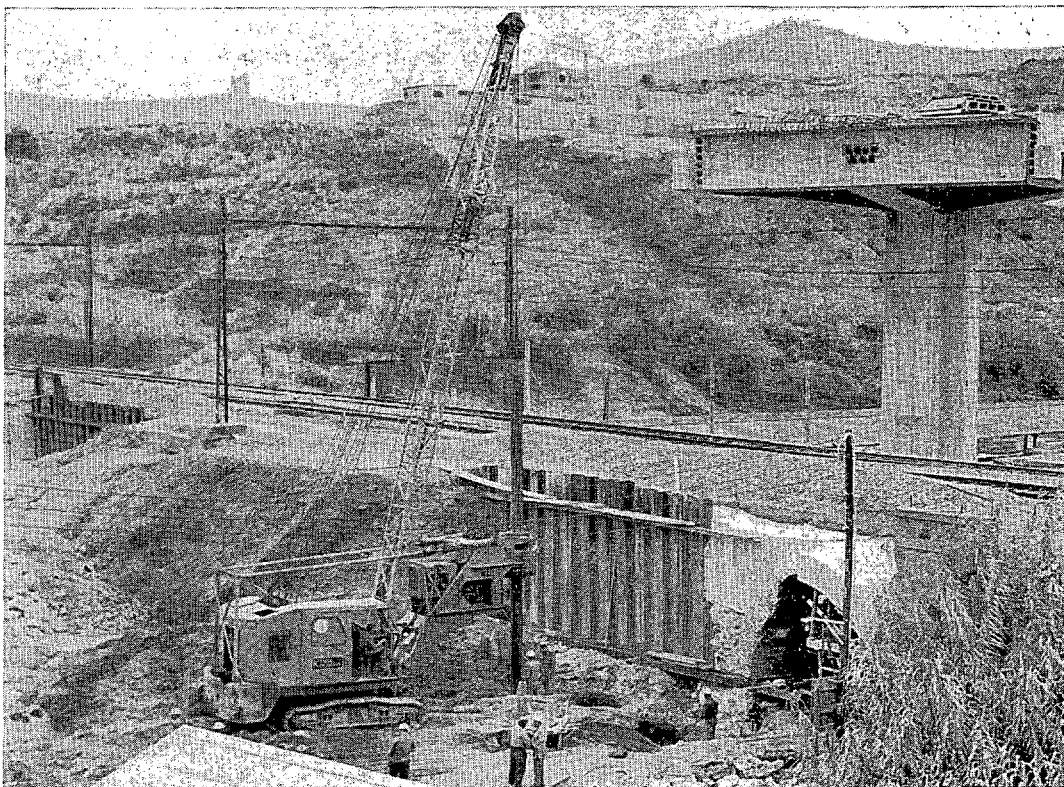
Cortes de terraplenes del ferrocarril realizados con tablestacas metálicas en las autopistas de Barcelona a la Junquera.
